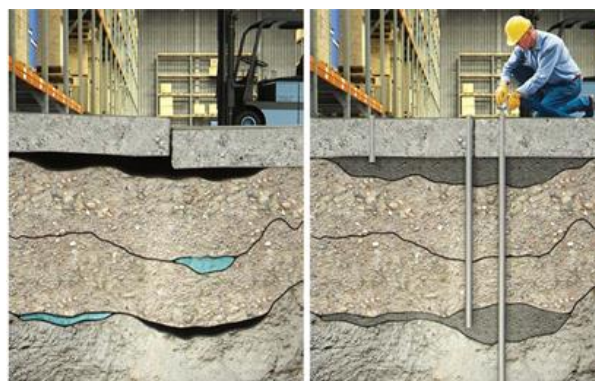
Підйом і вирівнювання бетонних підлог і плит перекриття
